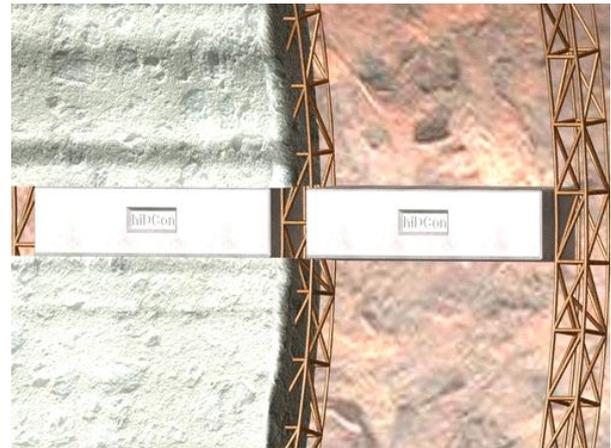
Einbau von hiDCon-Balkenelementen in der Spritzbetonschale (Installationsschema mit Gitterträgern)
